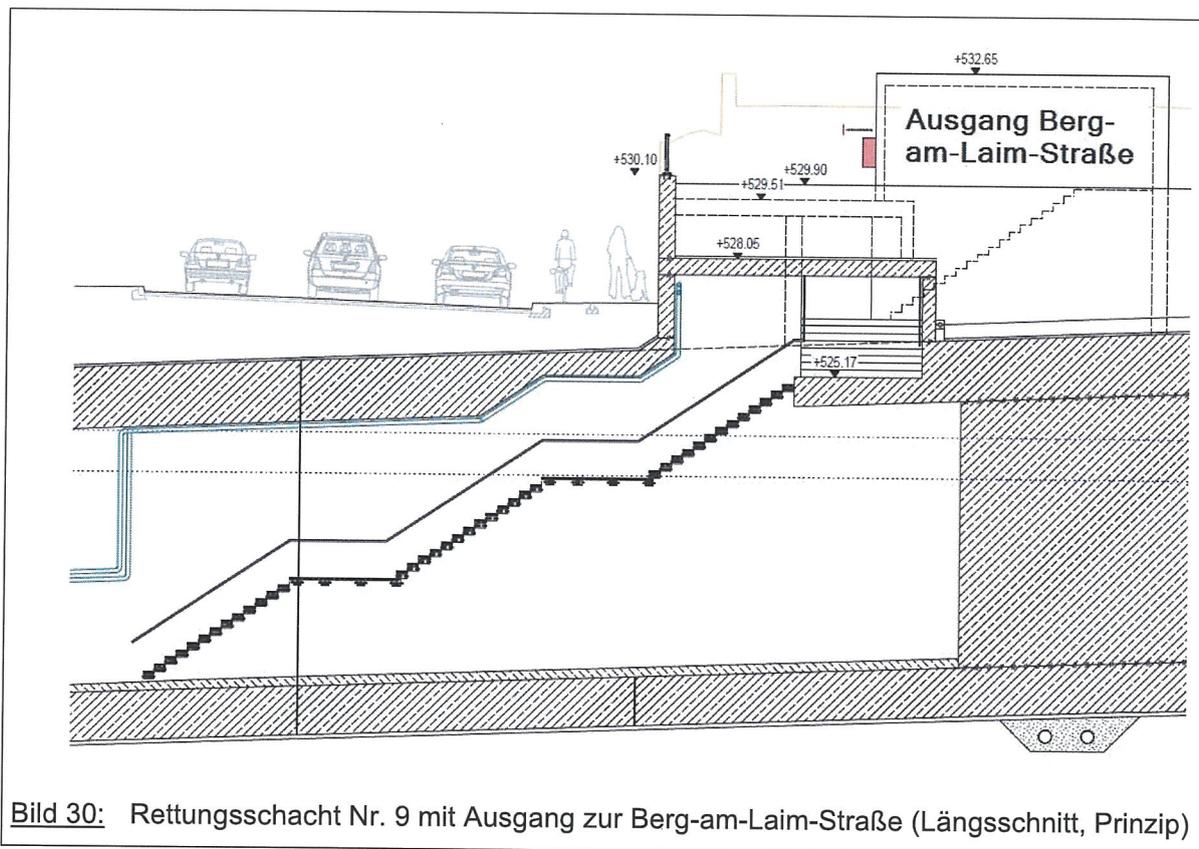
Rettungsschacht Nr. 9 mit Ausgang zur Berg-am-Laim-Straße (Längsschnitt, Prinzip)
